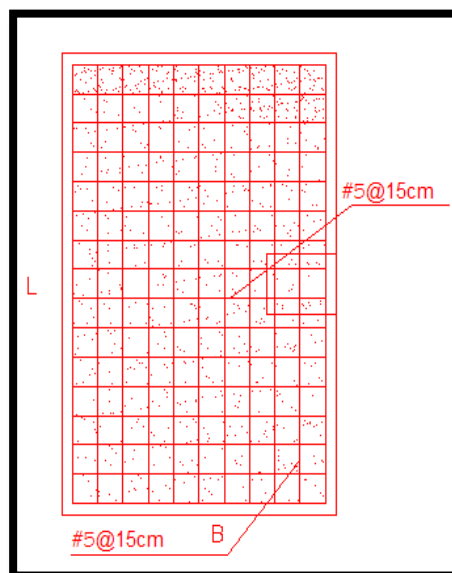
Vista en planta de la zapata con sus respectivos refuerzos.
